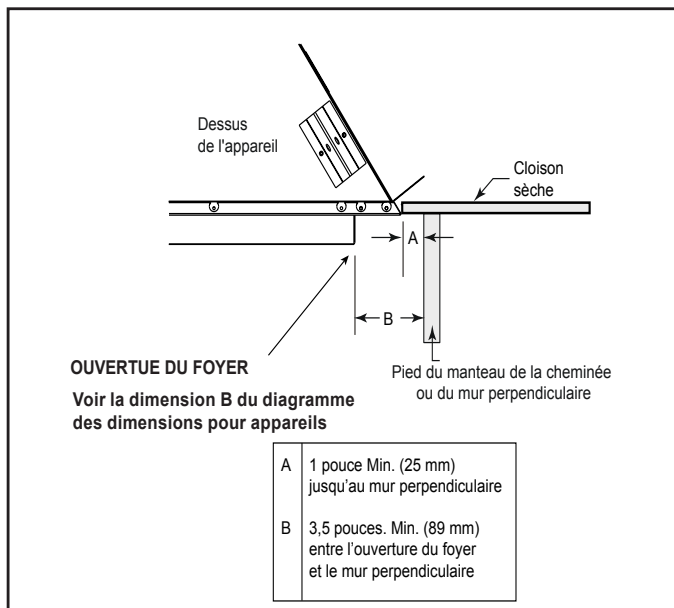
Jambes de manteaux de cheminée ou projections murales combustibles (Acceptables des deux côtés de l'ouverture)
